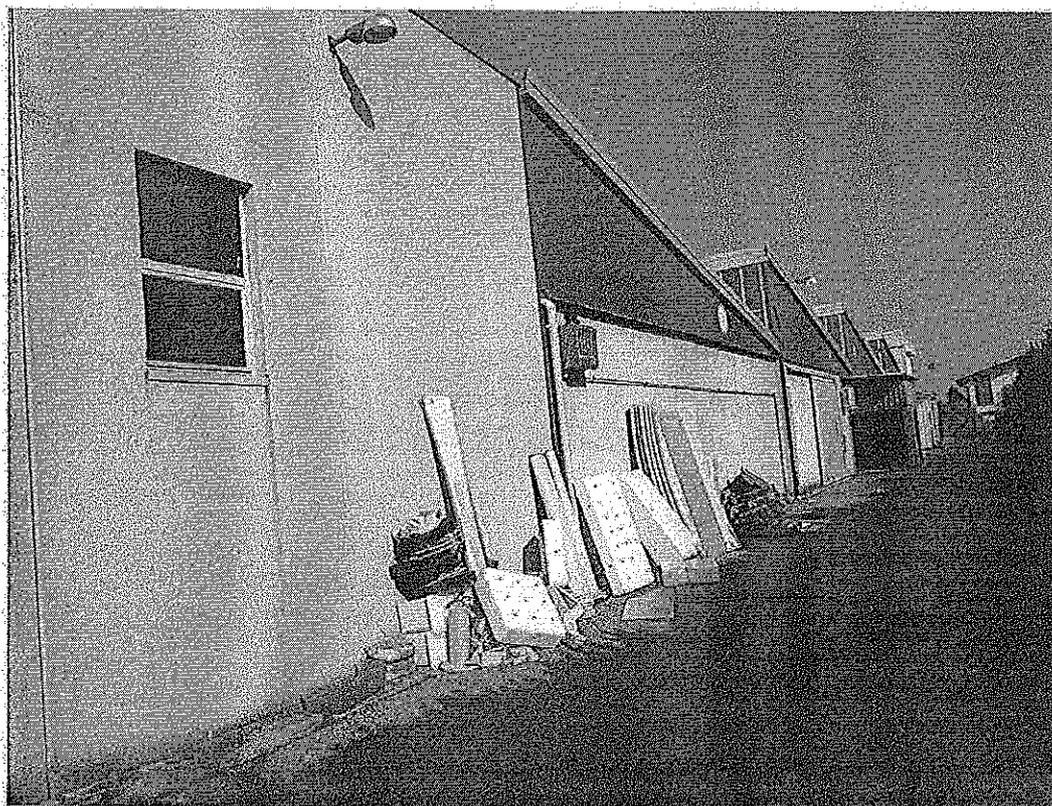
Corpo fabbrica nel fronte Ovest – vista esterna.
